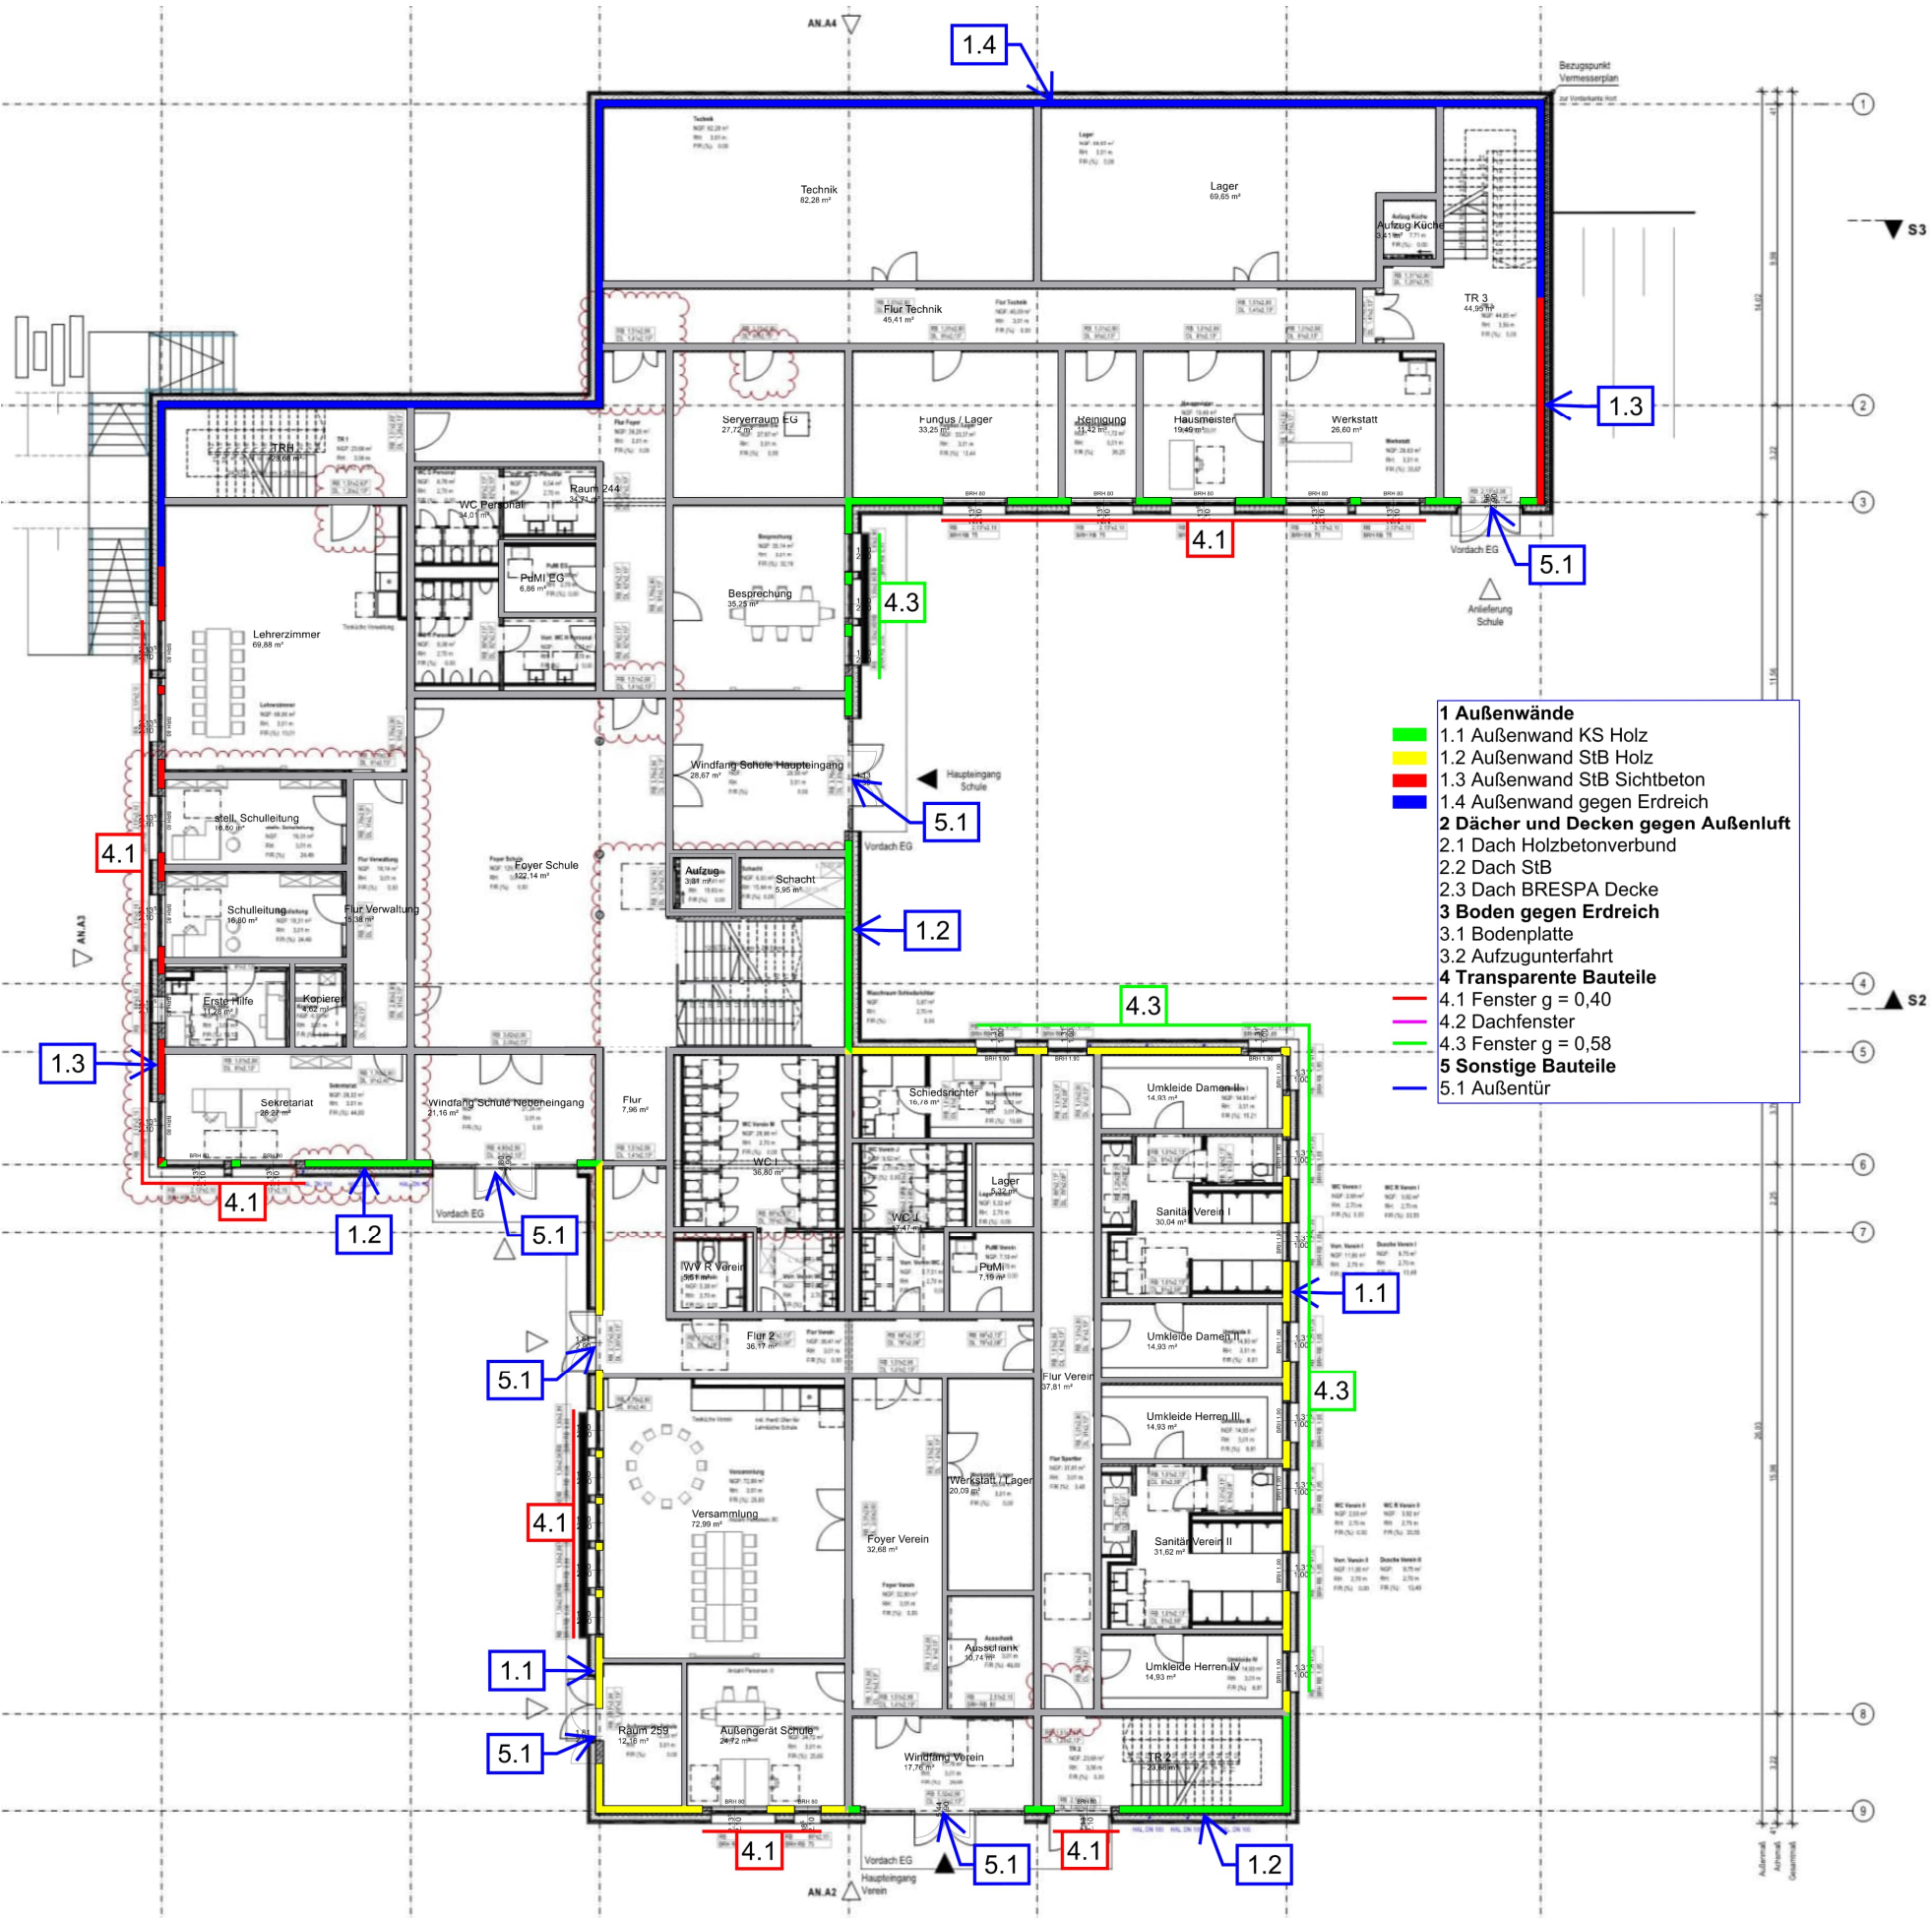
Bauteile Wände und Fenster Grundriss EG
